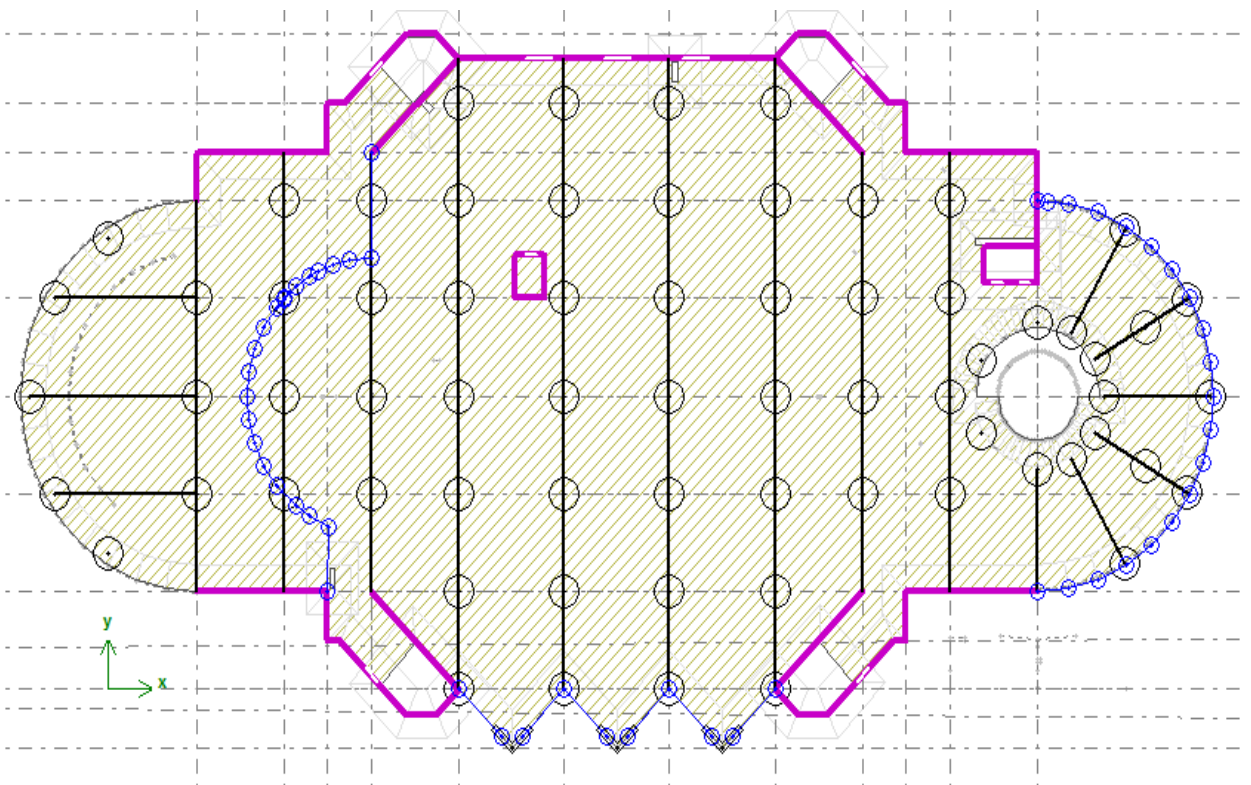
Розрахункова схема 2-го поверху будівлі
